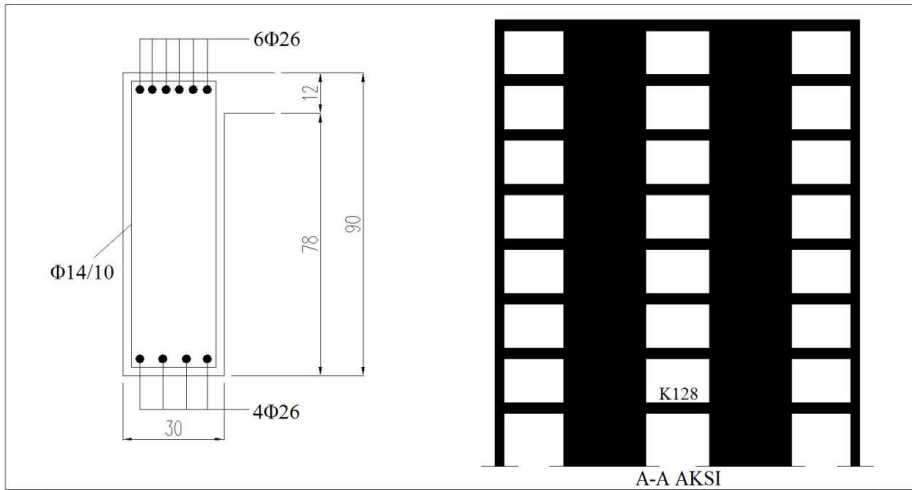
Örnek (30/60) kiriş kesiti ve betonarme detayı
